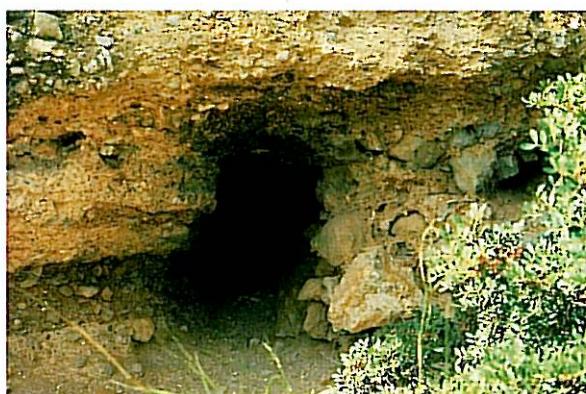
Taipa de Paderne. À esquerda, notam-se os estratos que compõem a assentada.
